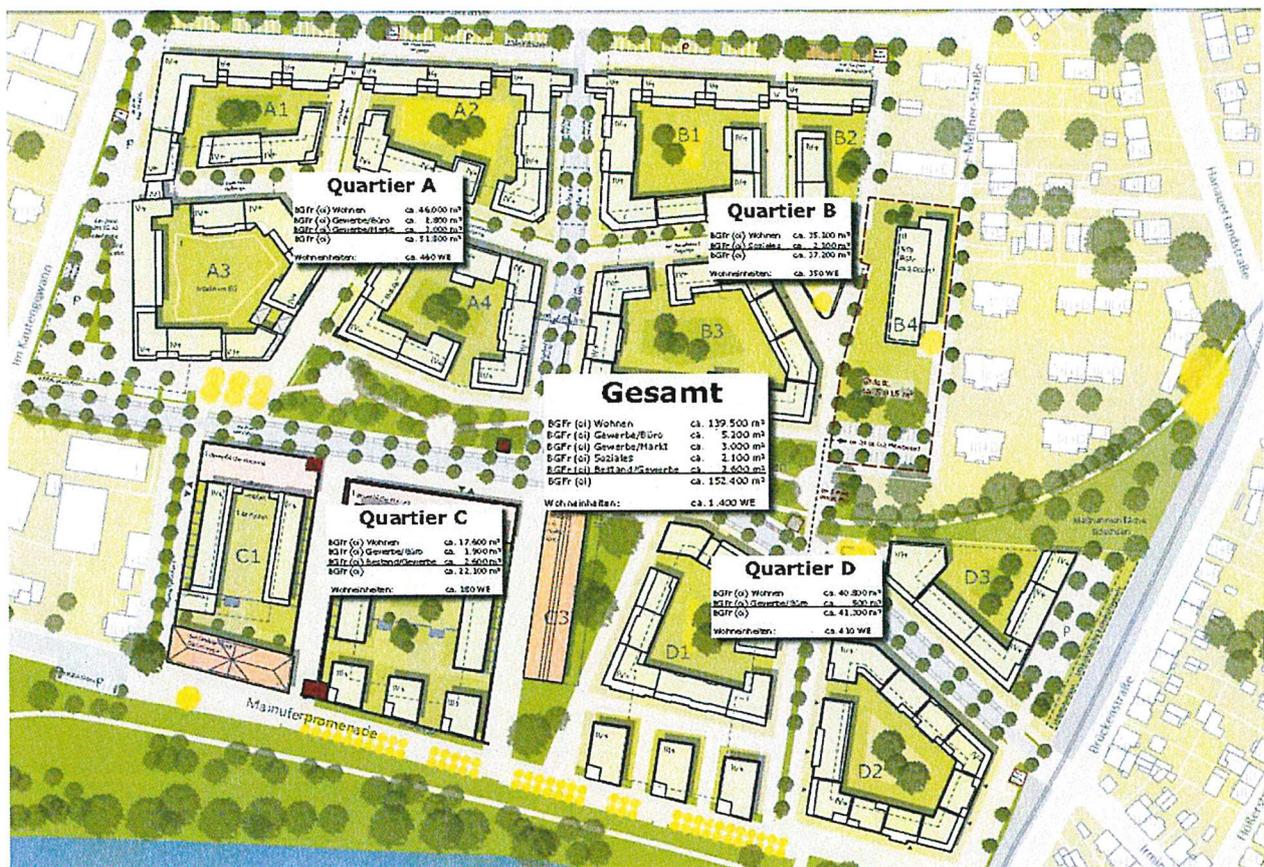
Bauvorhaben „Wohnbebauung, Josef-Bautz-Straße, 63457 Hanau“ – Auszug aus städtebaulichem Konzept [3] (Stand: März 2021)
